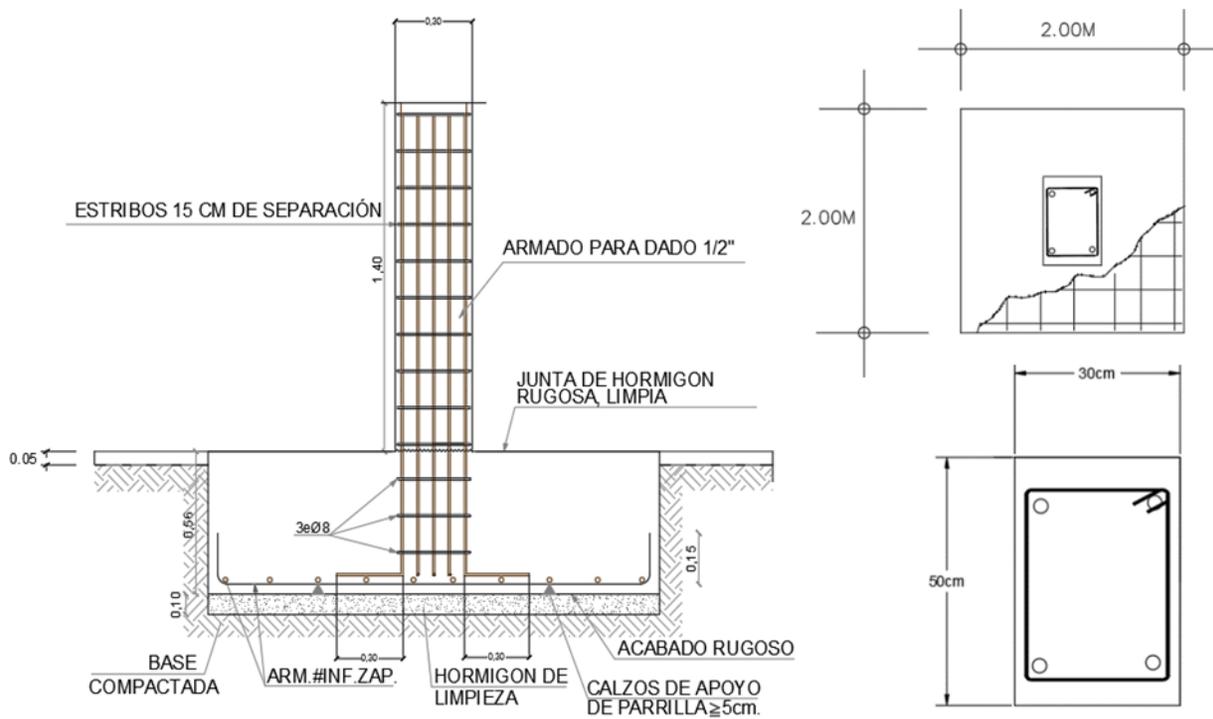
Detalle de zapata aislada / Fuente: Elaboración modificada de Buscador de Arquitectura (arq.com.mx)
